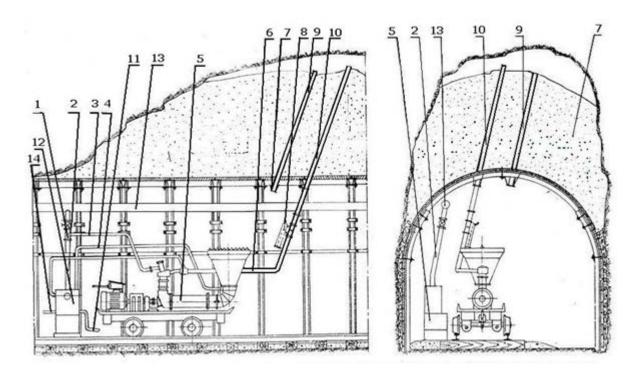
Заполнение пустот за крепью агрегатом типа «Монолит-3» Условные обозначения: 1 — разветвление; 2 — рукав питания; 3 — рукав промывки; 4 — рукав подачи воды в смесительную камеру; 5 — смесительно-нагнетательный агрегат; 6 — растворопровод; 7 — гипсовая закладка; 8 — переключатель потока; 9 — контрольная труба; 10 — выпускная труба; 11 — плана смыва утечек раствора; 12 — пульт управления; 13 — противопожарно-оросительный трубопровод; 14 — рукав слива
